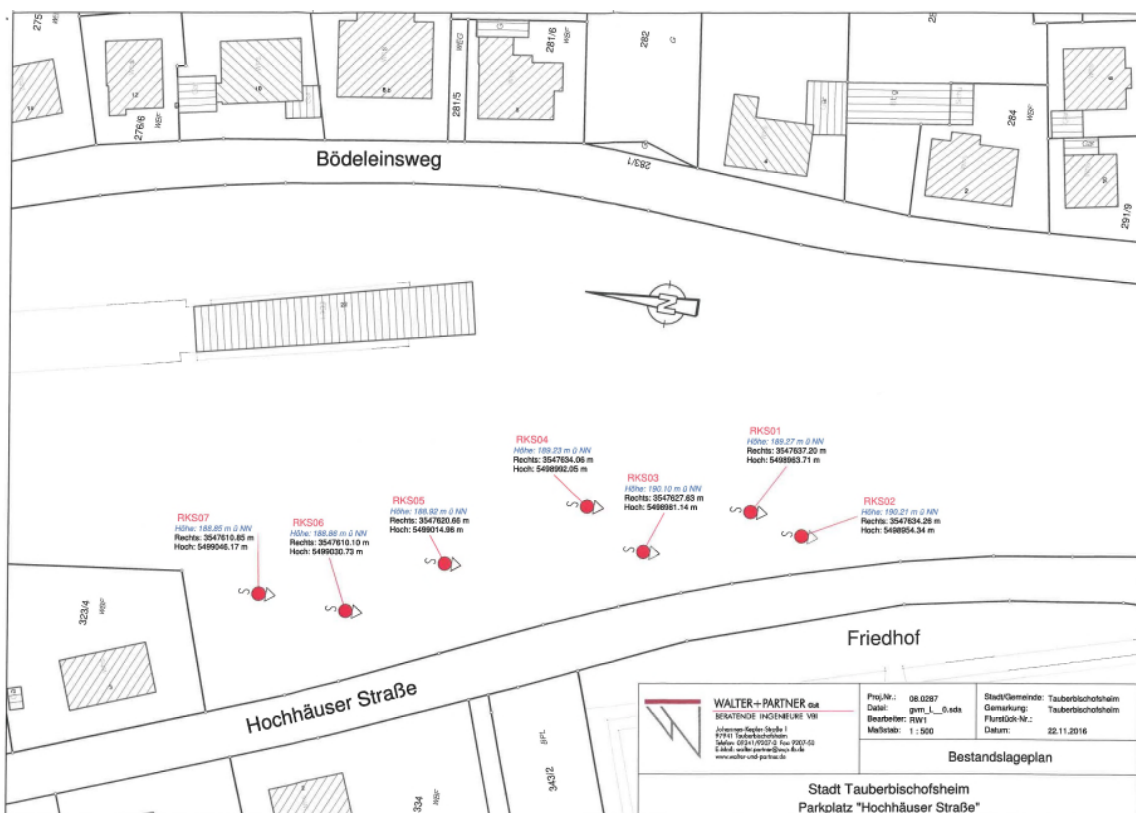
Lageplanausschnitt (o.M.) mit Darstellung der durchgeführten Rammkernsondierungen
